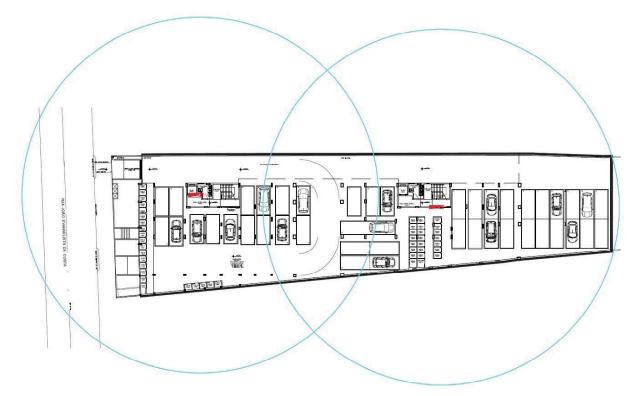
POSIÇÃO DOS ABRIGOS DE MANGUEIRA - PAVIMENTO SUBSOLO
